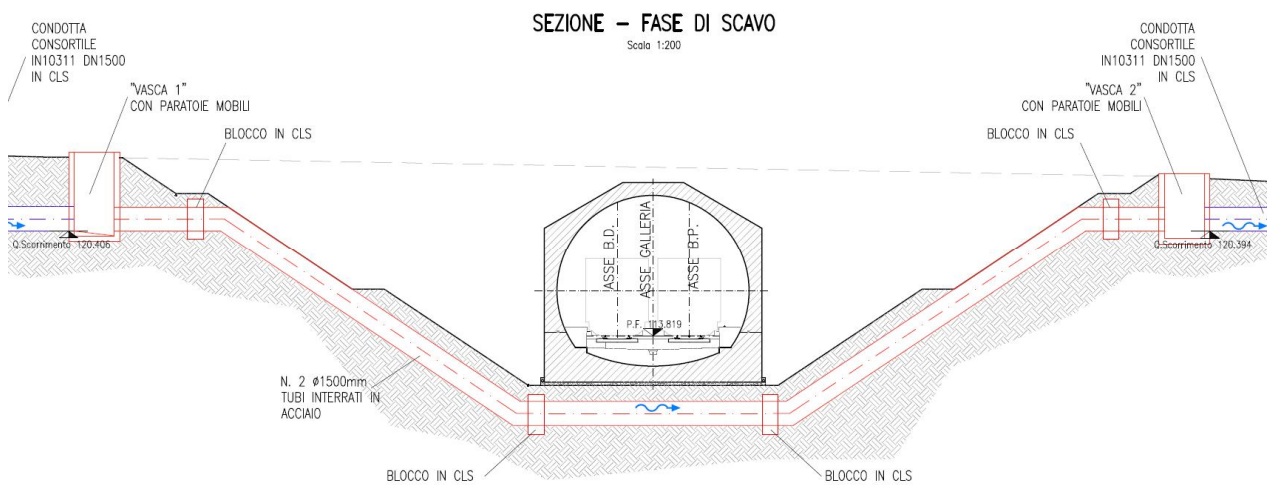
Deviazione del canale e realizzazione delle opere nel tratto di intersezione.
